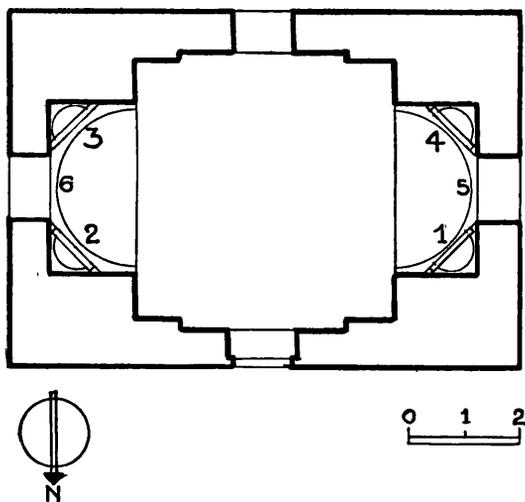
TOMBEAU DE ŞAFWAT AL-MOLK : Plan.
